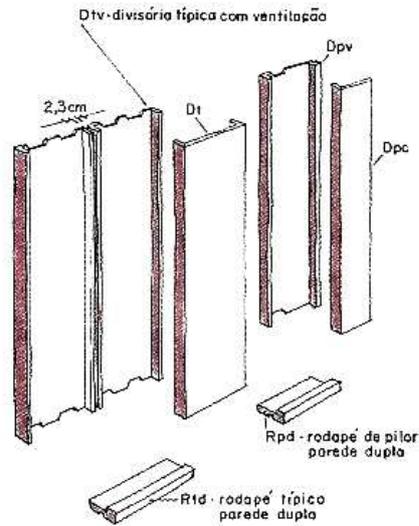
Peças pré-fabricadas para paredes externas com passagem de ar.
